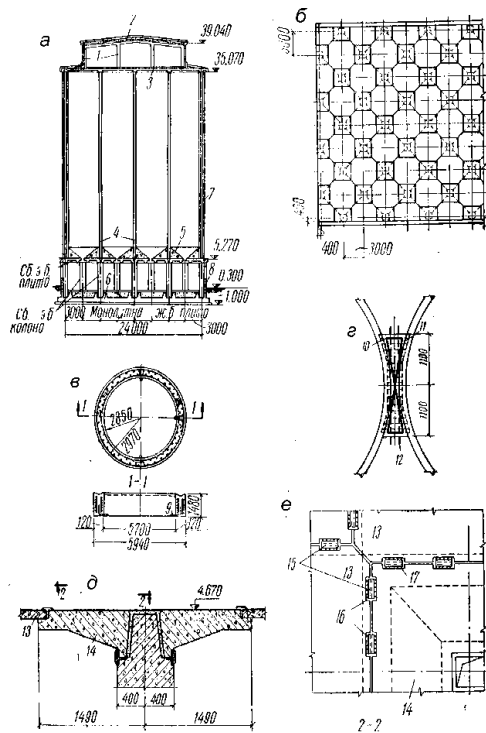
Силосний корпус, збірний із залізобетонних кілець: а- поперечний розріз; б-монтажний план підсилосного перекриття; в- збірне кільце силосної банки; г-колона; д, е-деталі кріплення елементів залізобетонного перекриття до колон; 1 - збірна залізобетонна рама; 2- великопанельні плити; 3-збірна залізобетонна плита; 4 - збірні залізобетонні кільця; 5- шлакобетон; 6 - монолітна залізобетонна плита; 7- пілястри в крайніх банках; 8- бетонні блоки; 9-петлі для монтажного риштування; 10 - арматурний каркас; 11- арматурна сітка; 12- виступ для кріплення опалубки; 13- підсилосна плита; 14-капітель; 15-металева накладка; 16-закладні деталі плити; 17- закладні деталі капітелі
